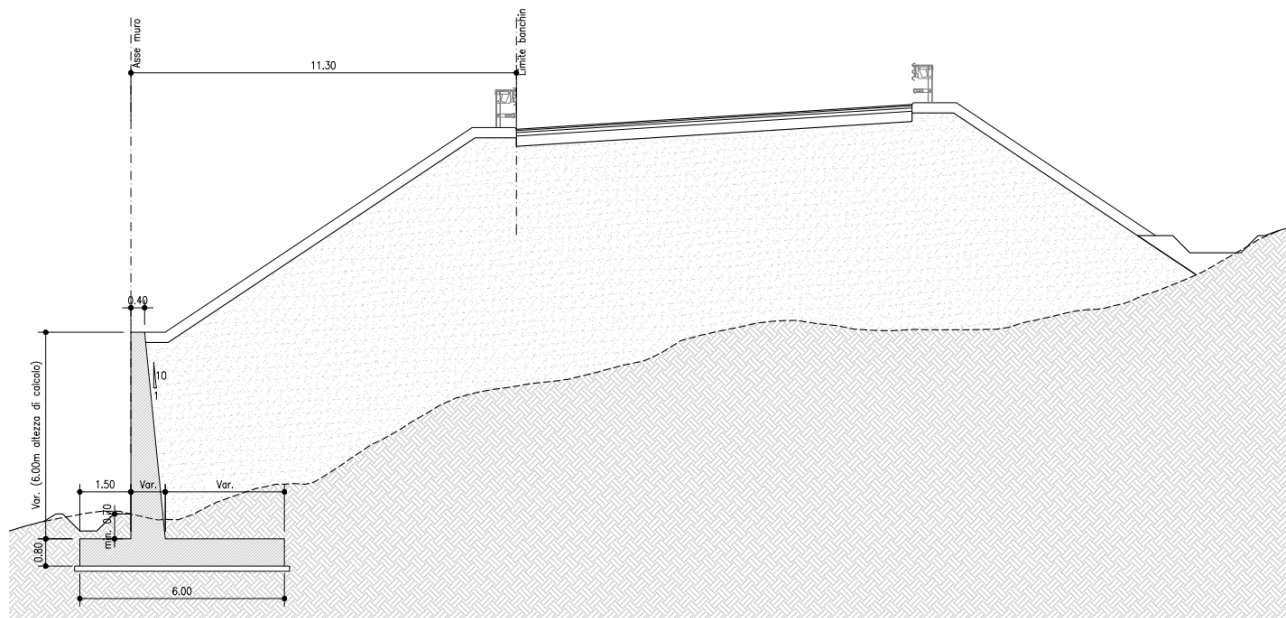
Muro ad L - Sezione trasversale - Conci 2 e 3
